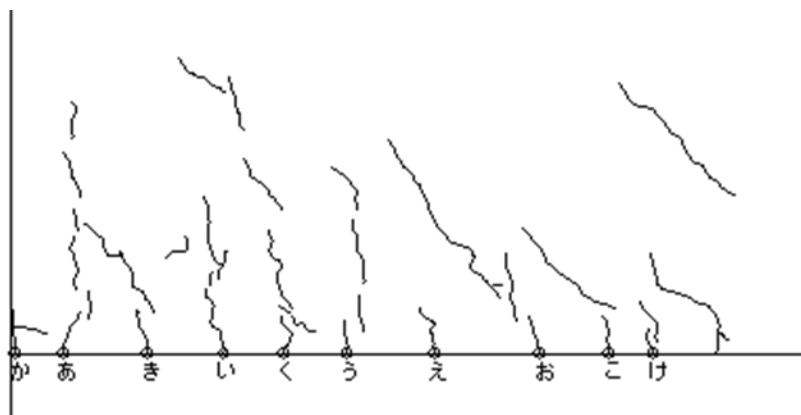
基礎梁ひび割れ幅測定位置(試験体 A-5 正載荷)
